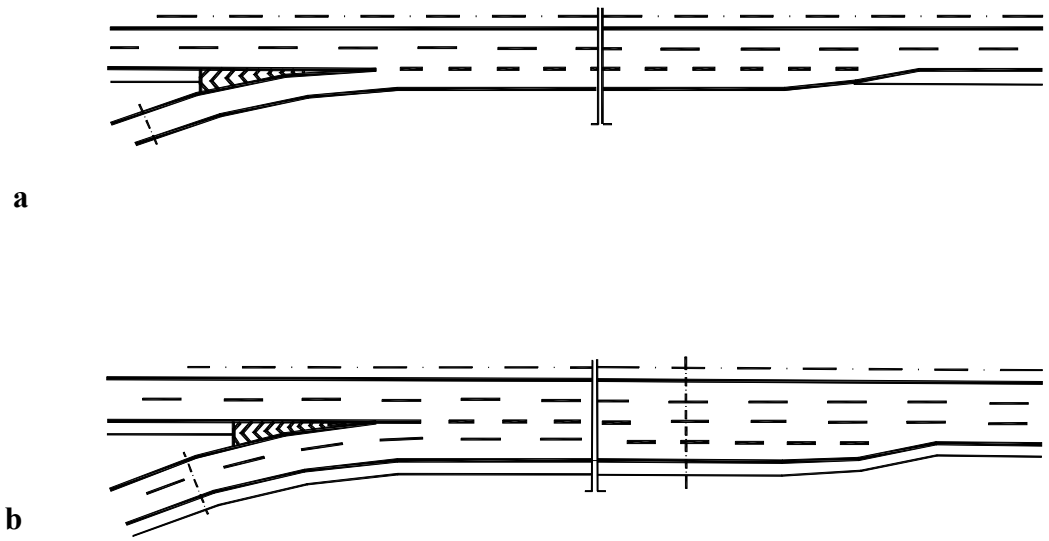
(a,b) – Schema geometrico delle rampe di immissione
